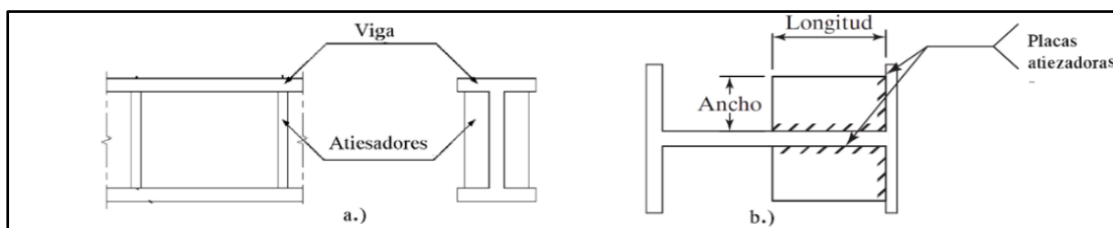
a) Atiesadores en vigas; b) Atiesadores en columnas. BonillayTapia (2010)
